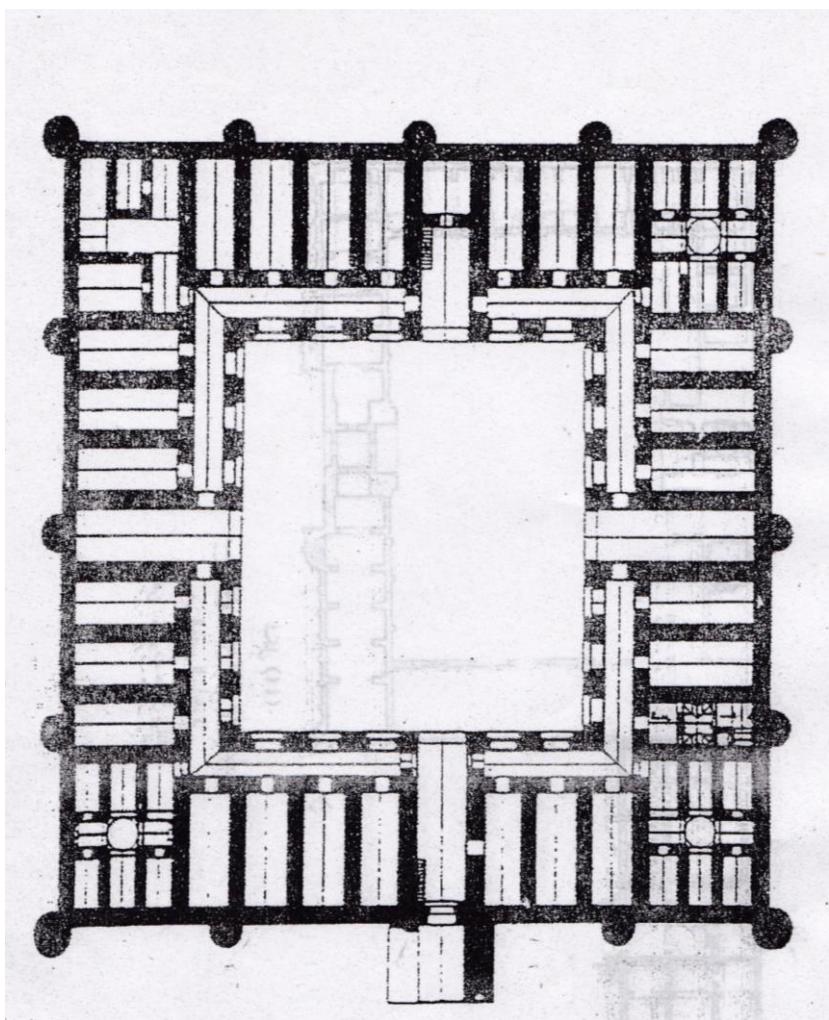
مسقط افقي لخان رباط الملك من العصر السلجوقي
